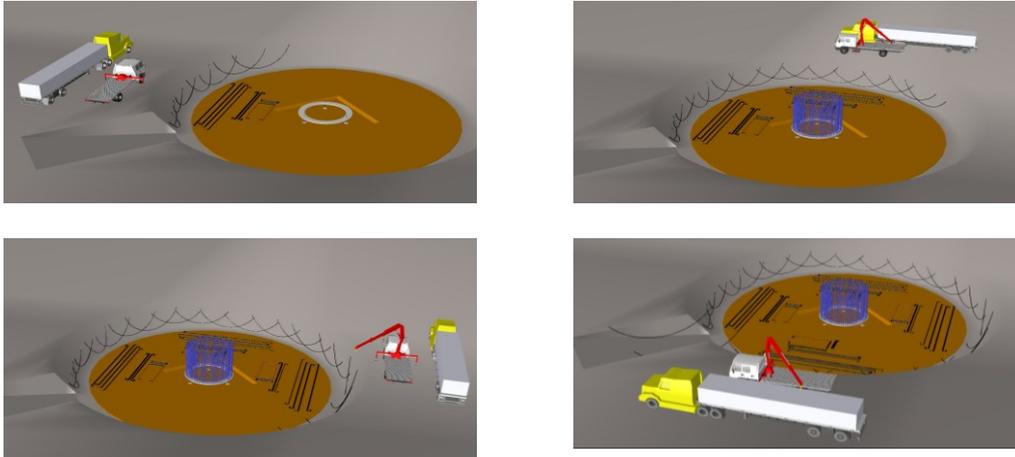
Pontos de parada da 1ª carreta para descarregamento
